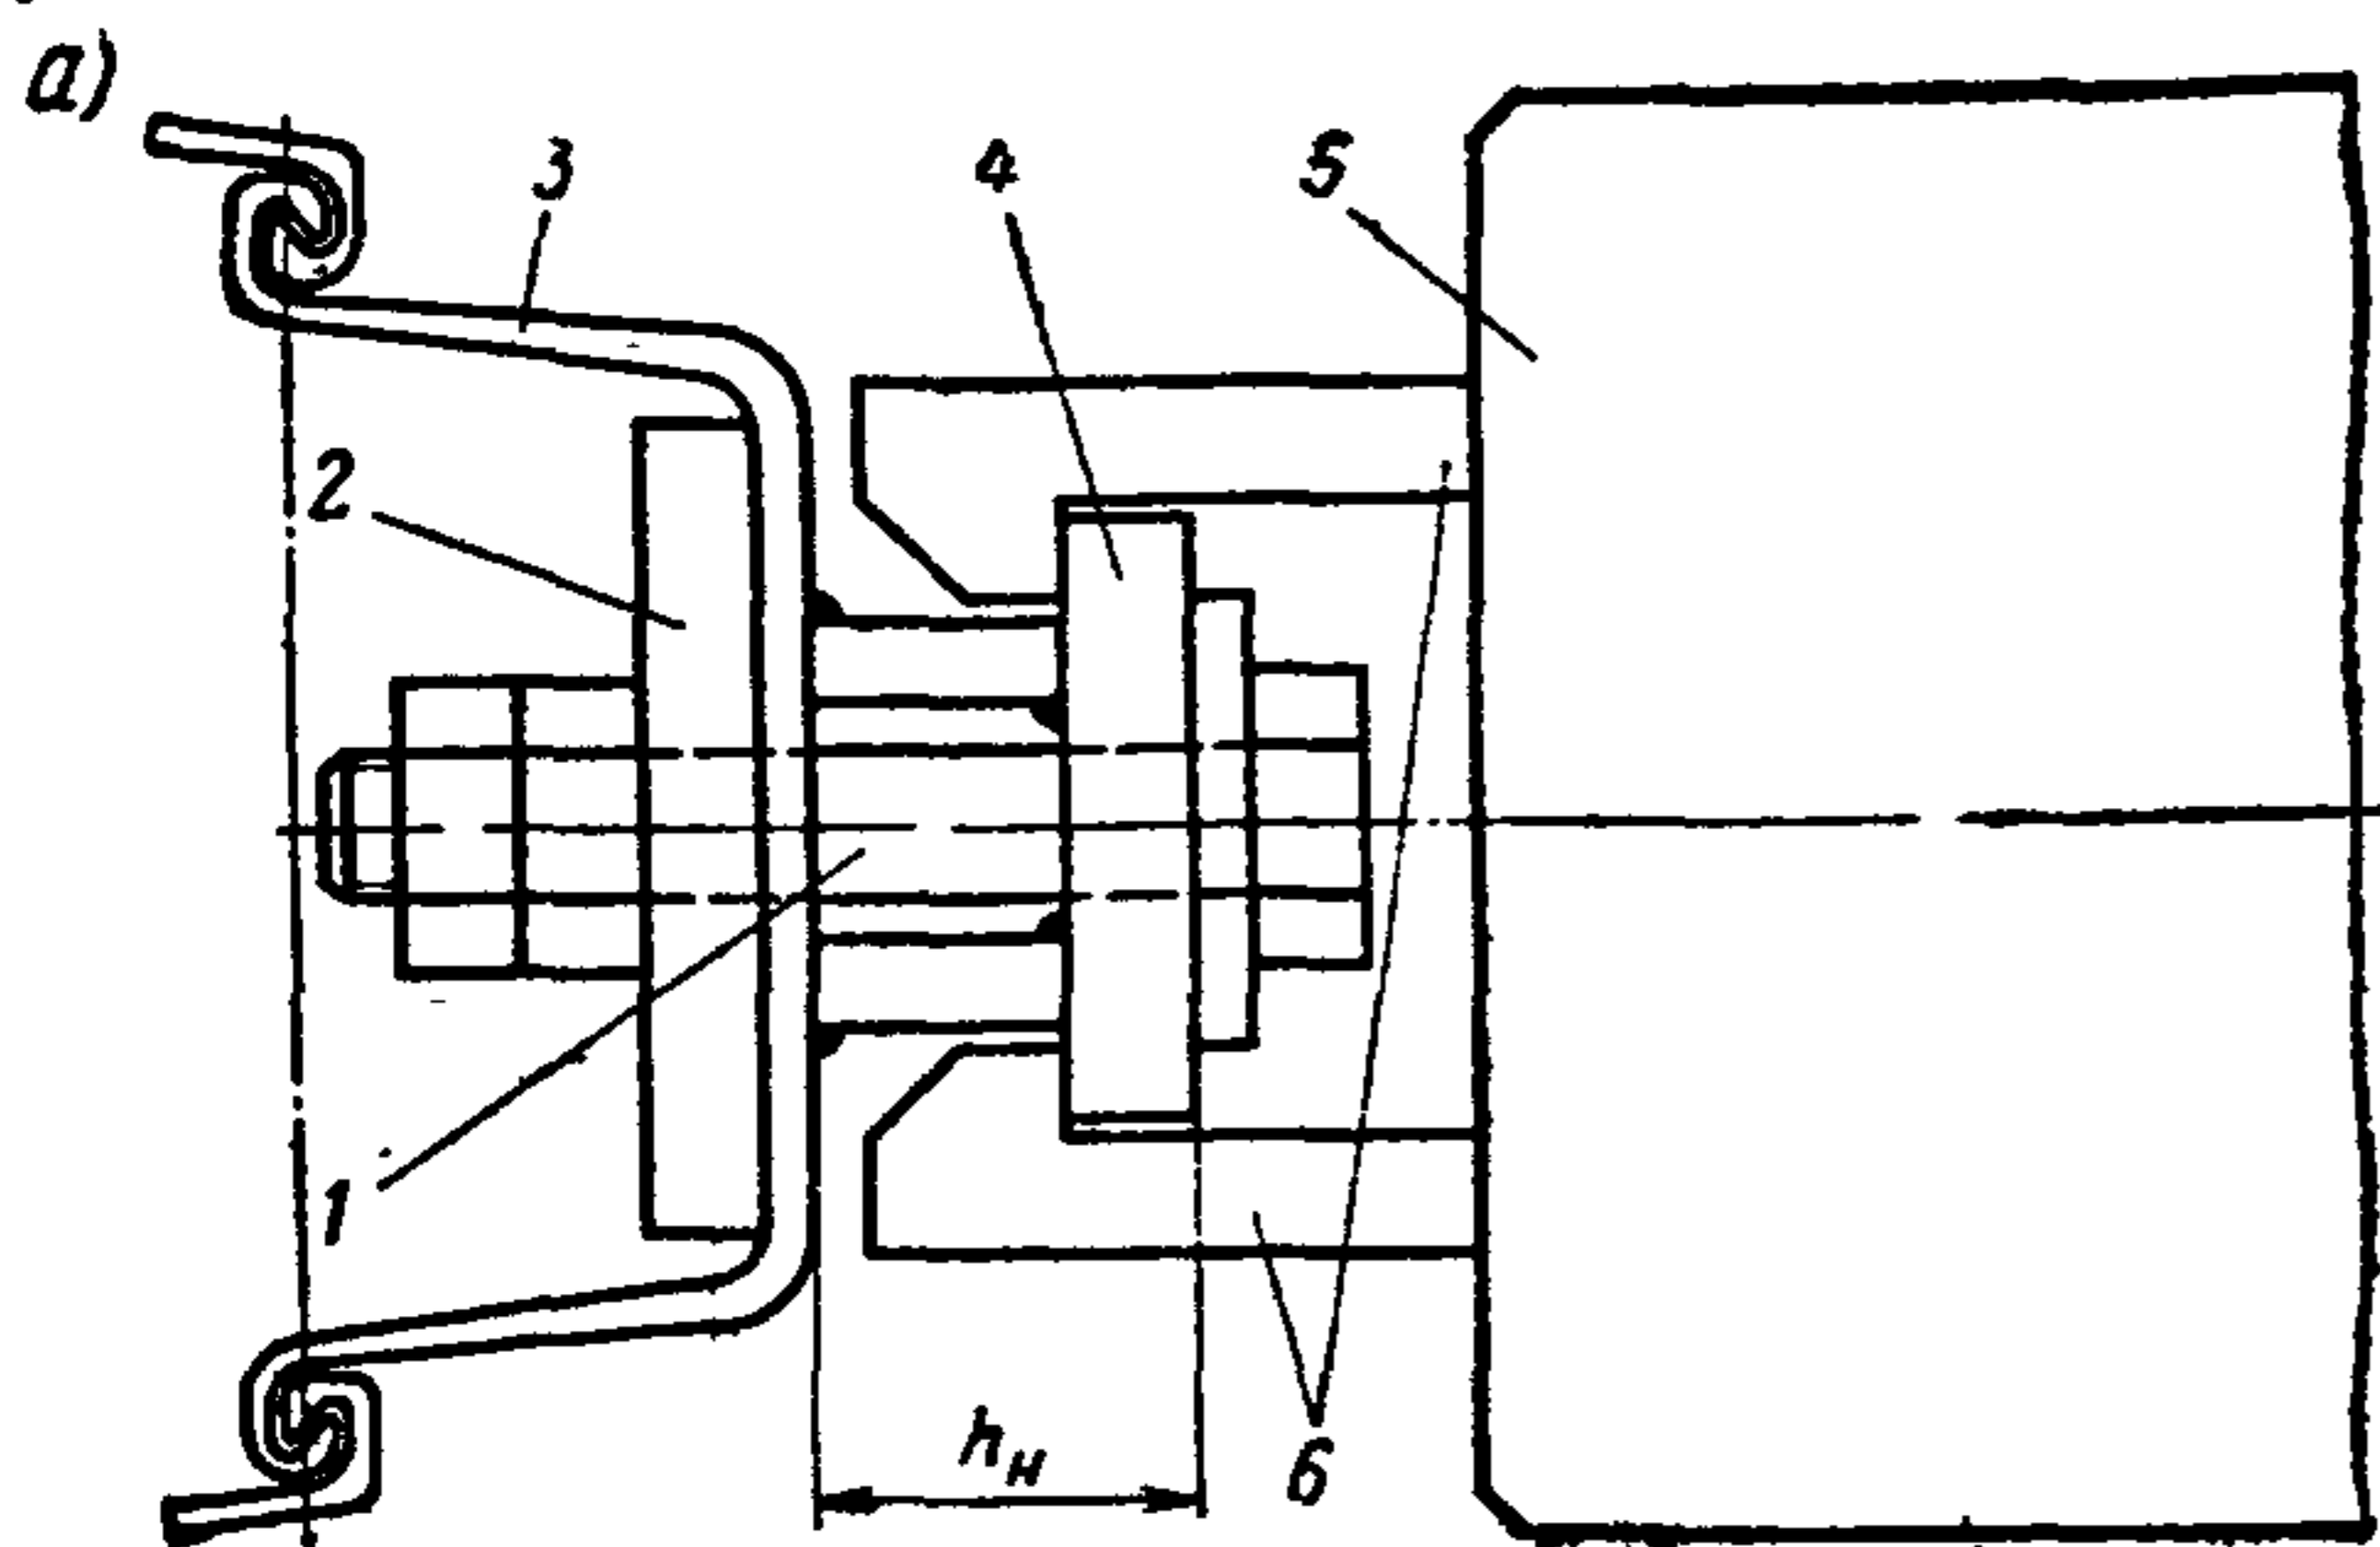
Варианты соединения анкерной плиты со шпунтовой стенкой:
